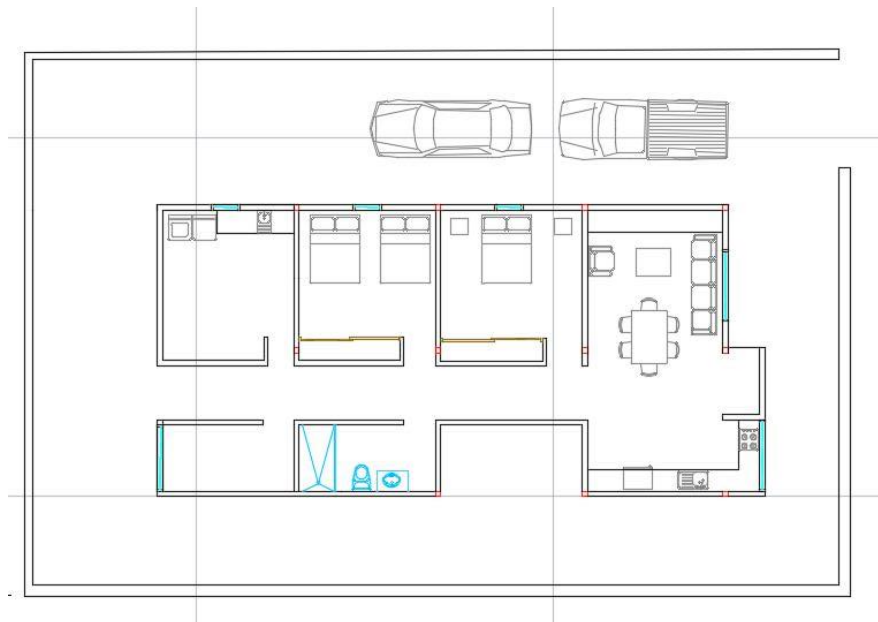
3 Vista de planta da instalação (Adaptado *AutoCAD*)
